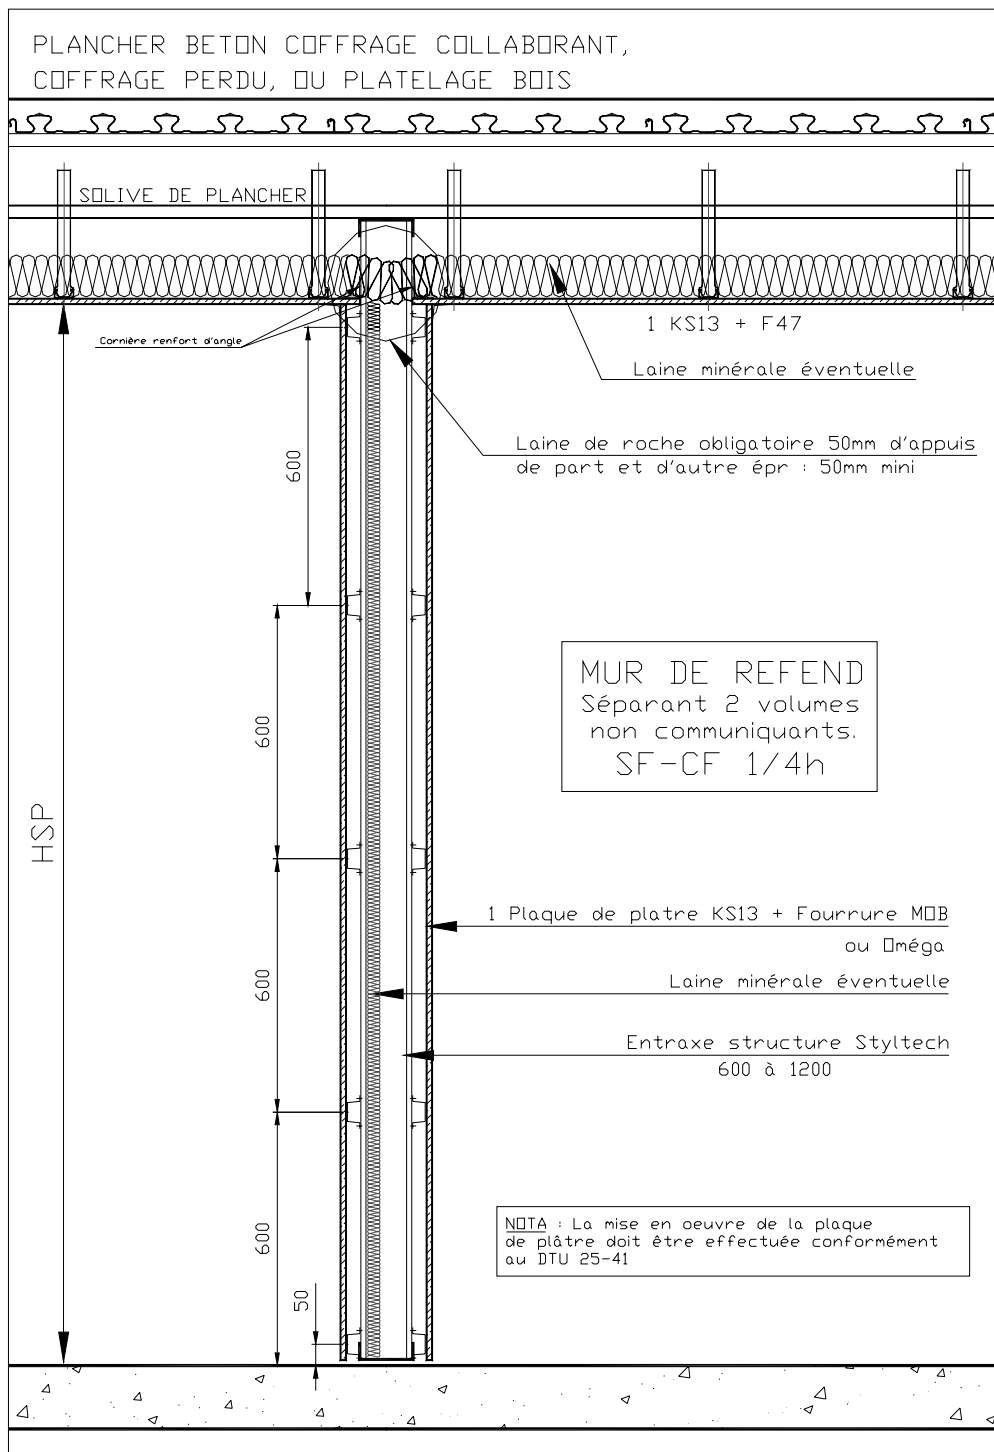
Plancher béton coffrage collaborant, coffrage perdu ou platelage bois
